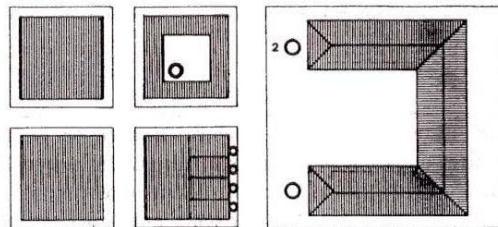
1.- Manzanas de la zona urbanizada, 2.- Pozo para drenaje de techos, 3.- En el interior de manzana, 4.- Individuales en terrenos menores.
